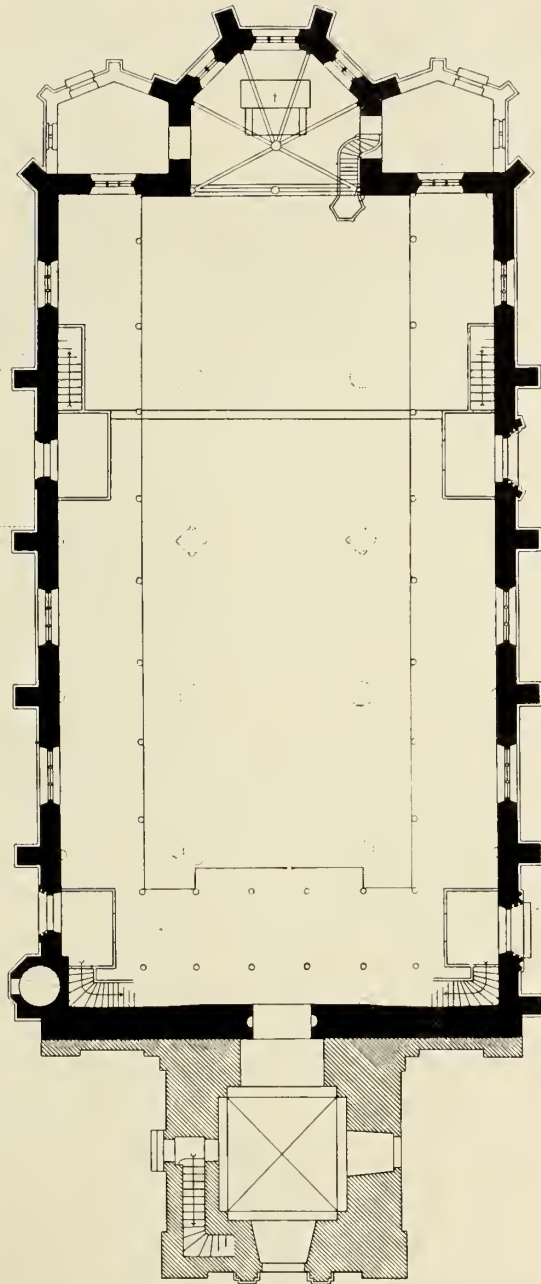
Hannover; Ägidienkirche, Grundriß.
